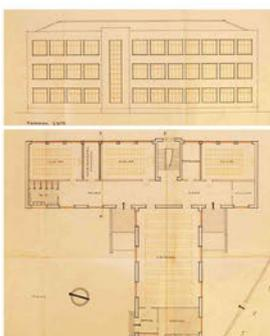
Colegio Público Padre Manjón, Alicante, 1934. Miguel López. Planta y alzado este. Archivo Histórico Municipal de Alicante (AHMA).
